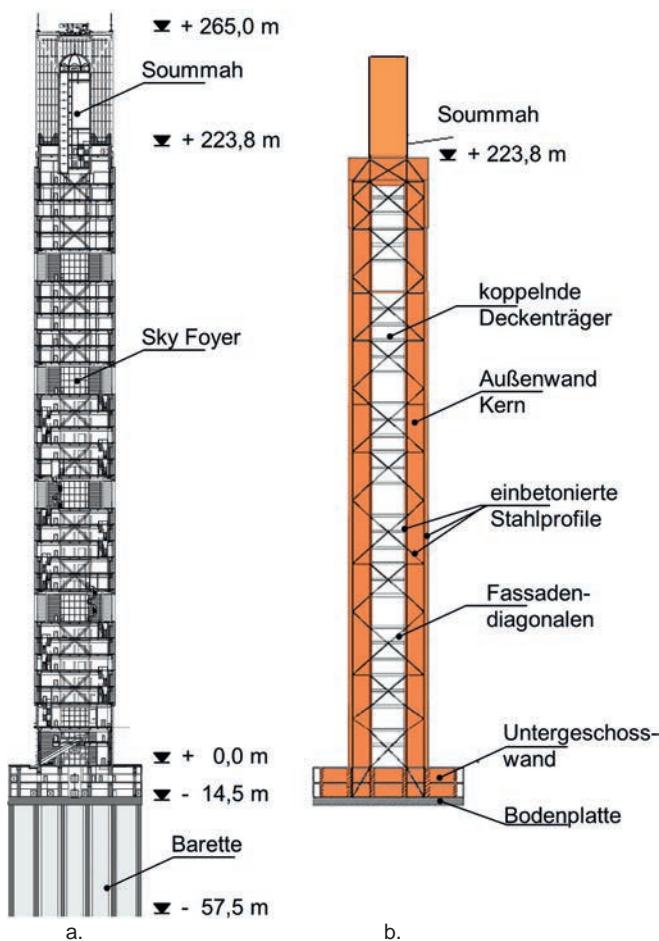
Das Minarett: (a) Vertikalschnitt, (b) das Aussteifungssystem mit den koppelnde Fassadendiagonalen und den in den Kernwänden einbetonierten Stahlelementen
